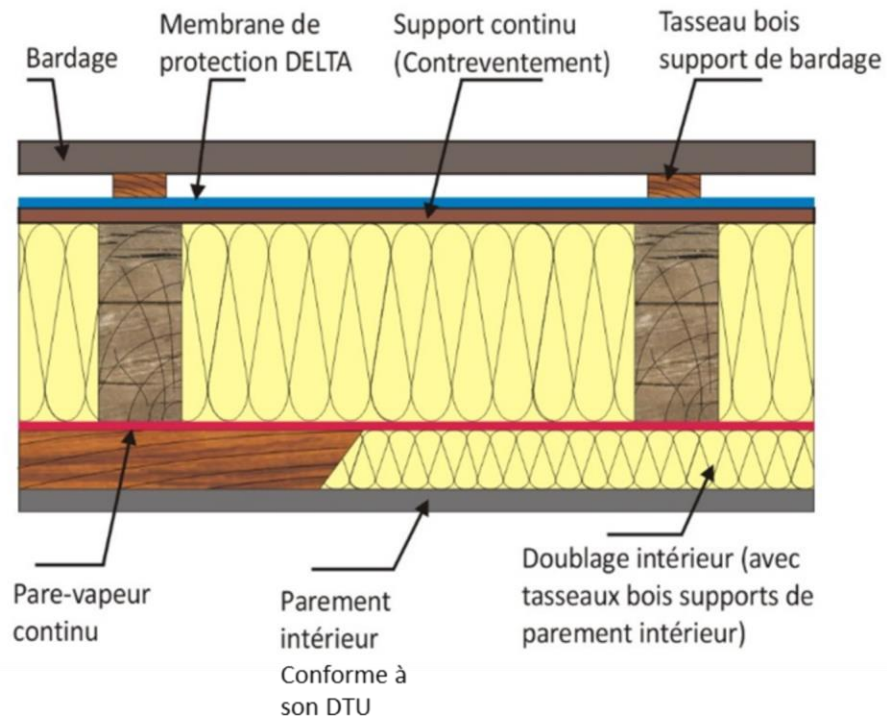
Coupe verticale de la membrane de protection à l'eau avec isolation complémentaire supportée entre montant sur support continu
